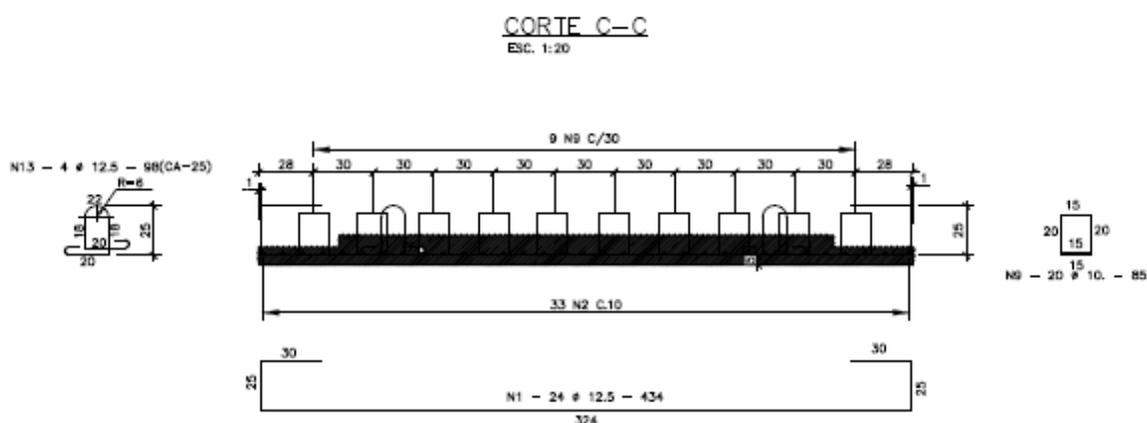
Detalhe da alça para içamento de pré laje em CA-25
